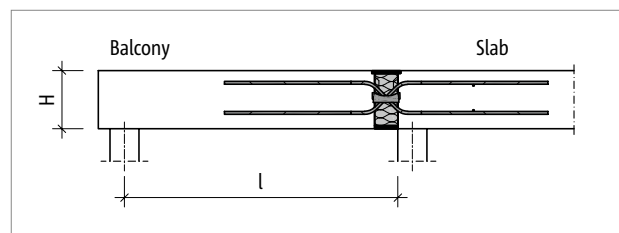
Schöck Isokorb® T type Q-E-VV: Static system
